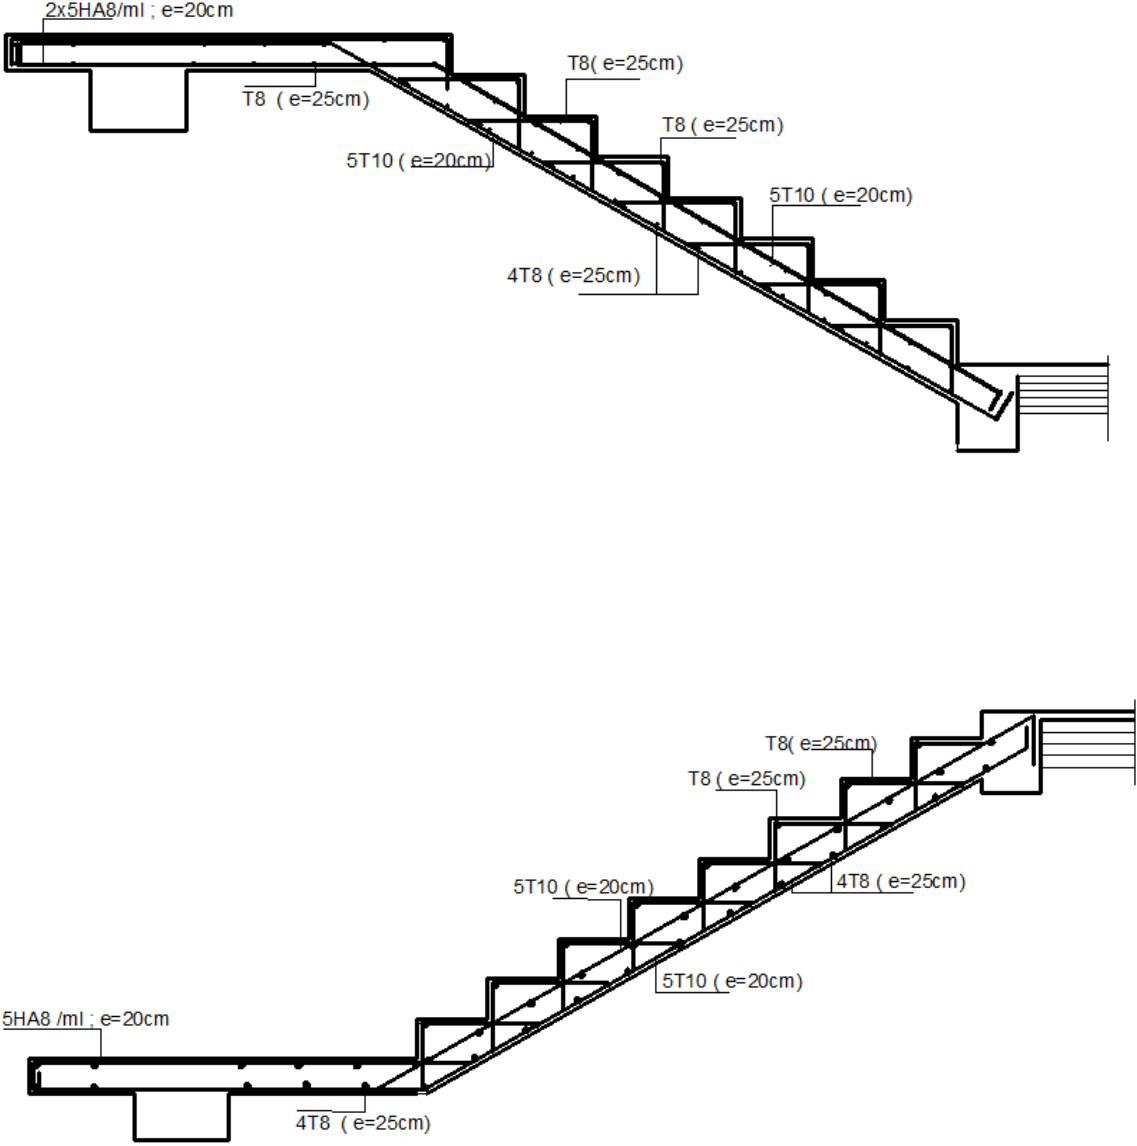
Le ferrailage de l'escalier volée 1 et 2
